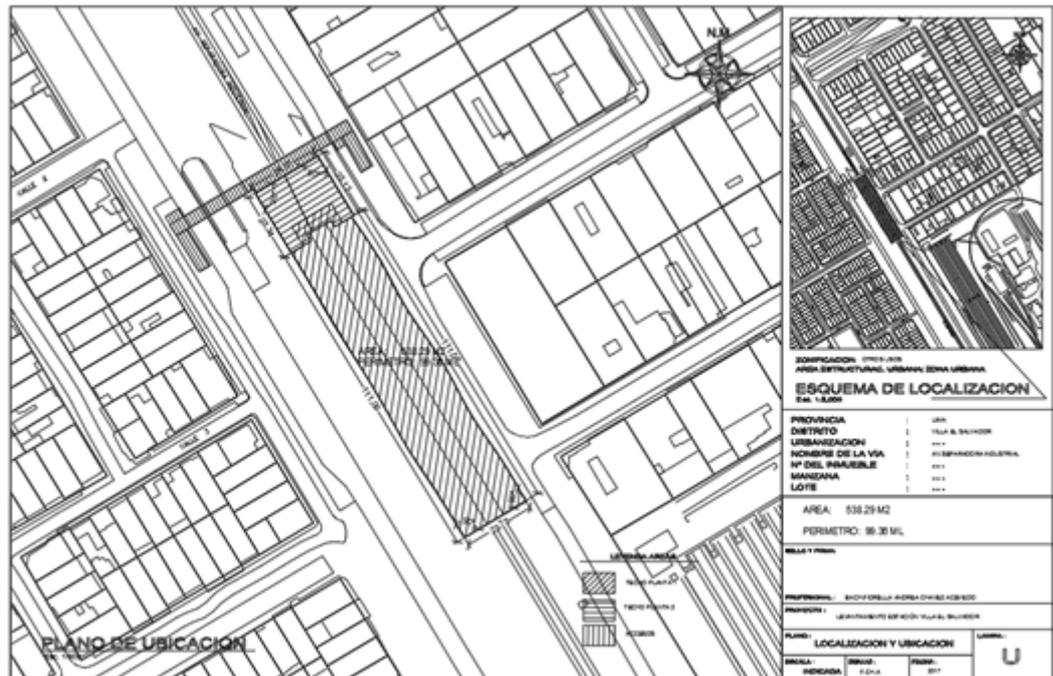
Plano de Situación de la Estación Ferroviaria de Villa El Salvador
